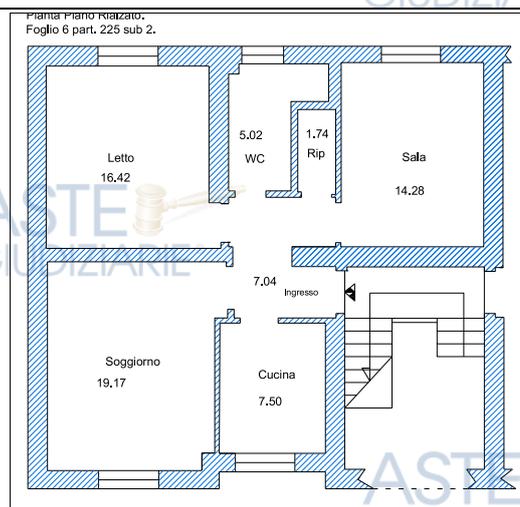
/b. Pianta rilevata in sede di sopralluogo.
